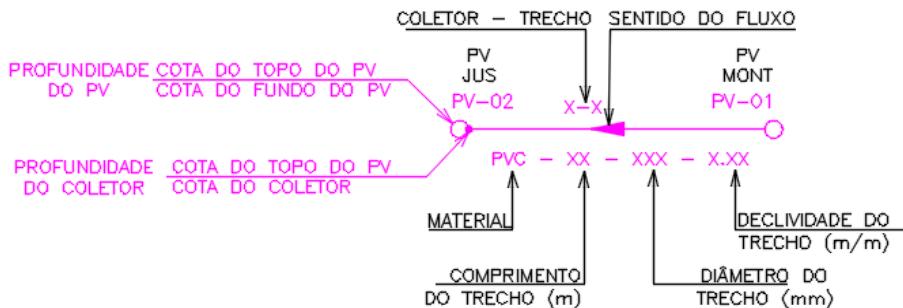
Convenções em planta da rede de esgotamento sanitário
